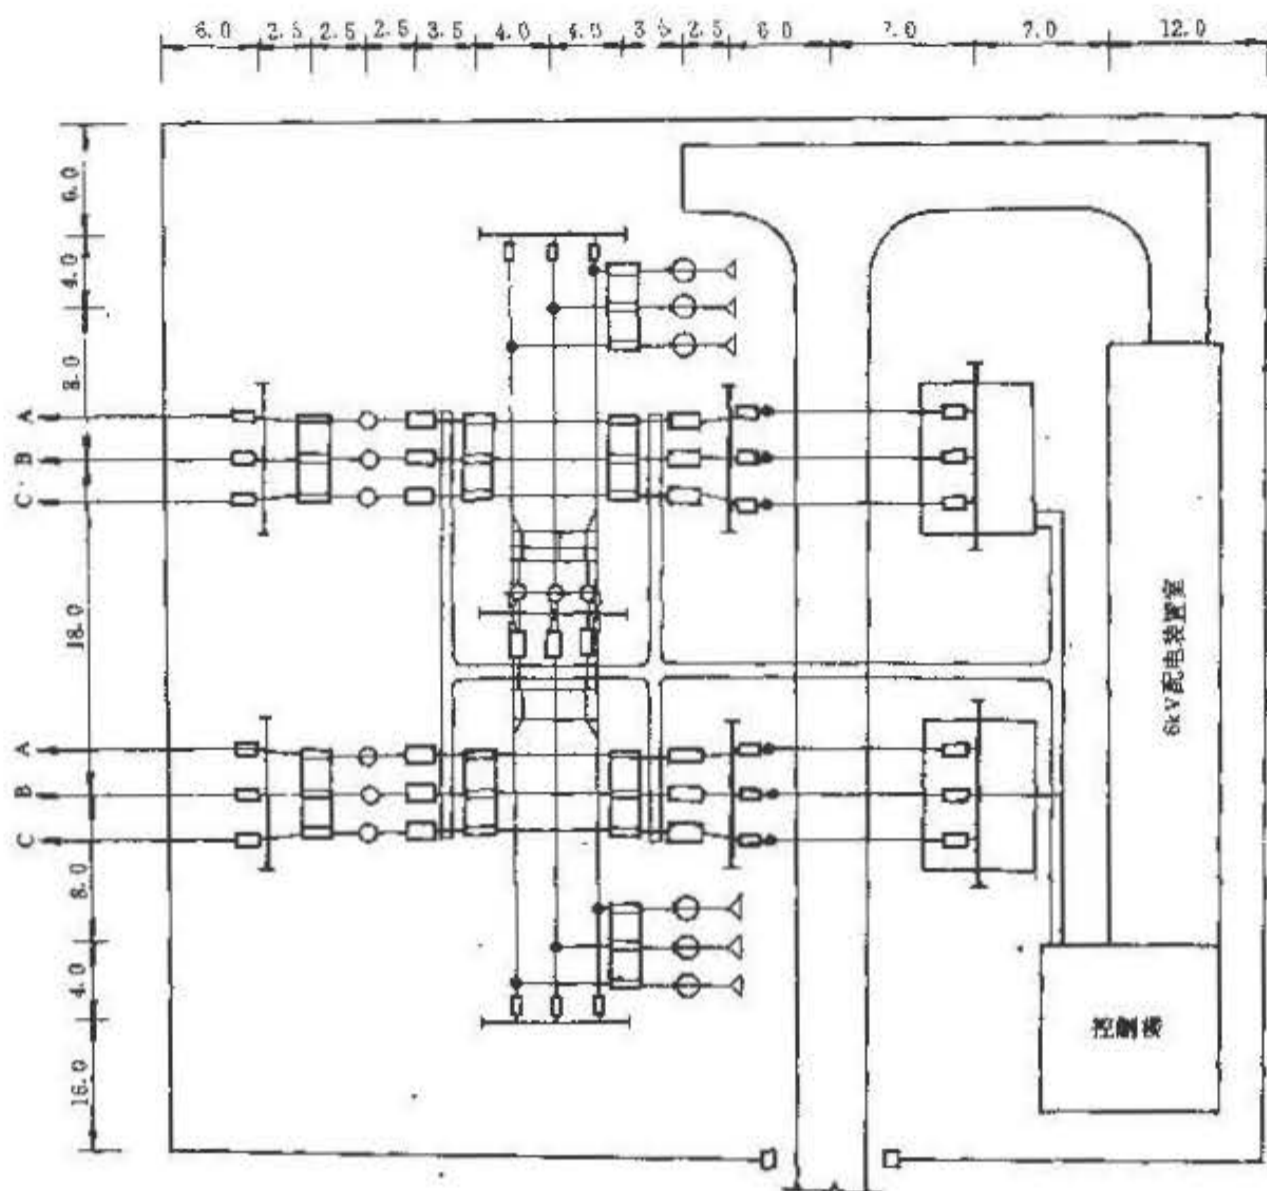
110/6kV 变电所总平面图 (图中单位为 m)
